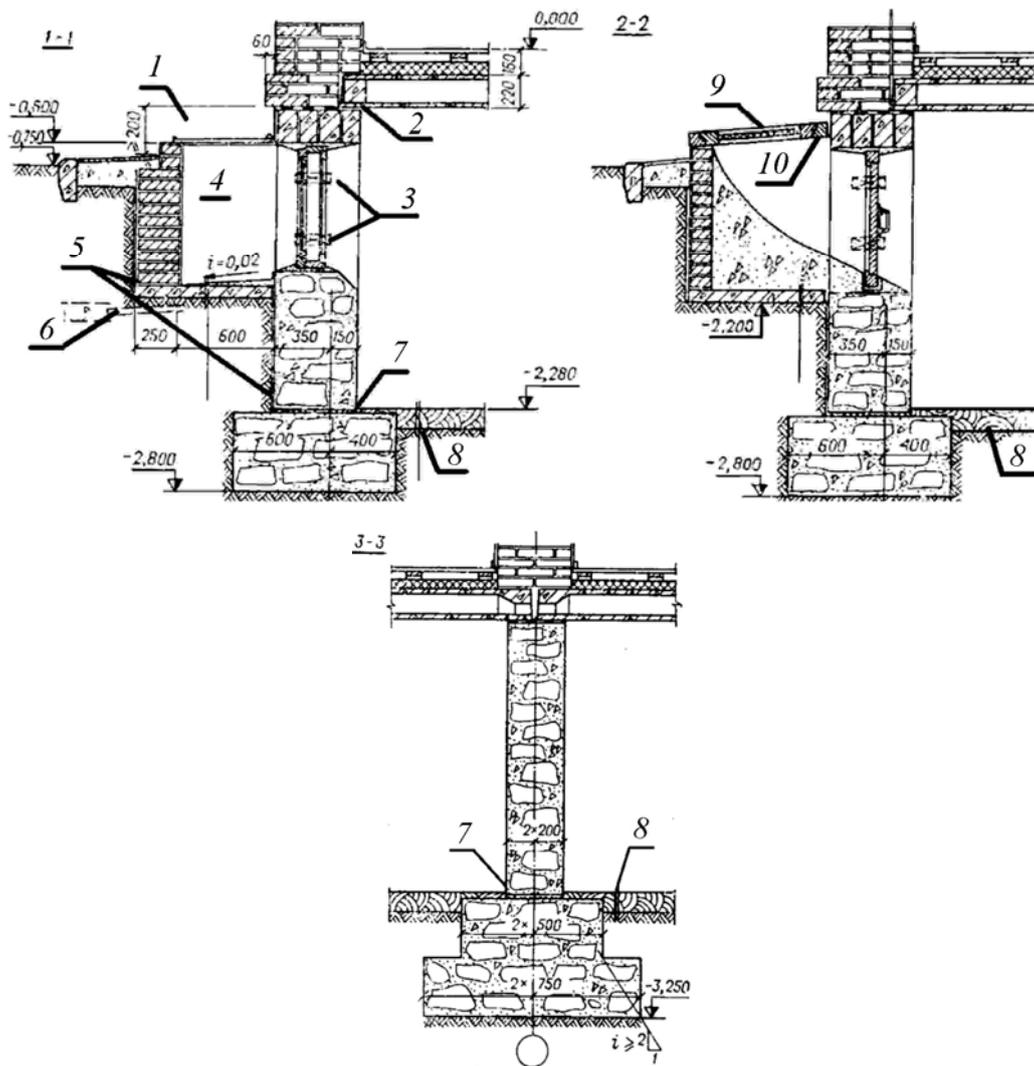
Сечения фундаментов из бутового камня: 1 — стальная решетка; 2 — противокapиллярная изоляция; 3 — антисептированные пробки; 4 — световой приямок; 5 — обмазка горячим битумом (2 раза); 6 — дренаж; 7 — противокapиллярная изоляция цементным раствором; 8 — глинобетон; 9 — крышка люка; 10 — загрузочный люк
